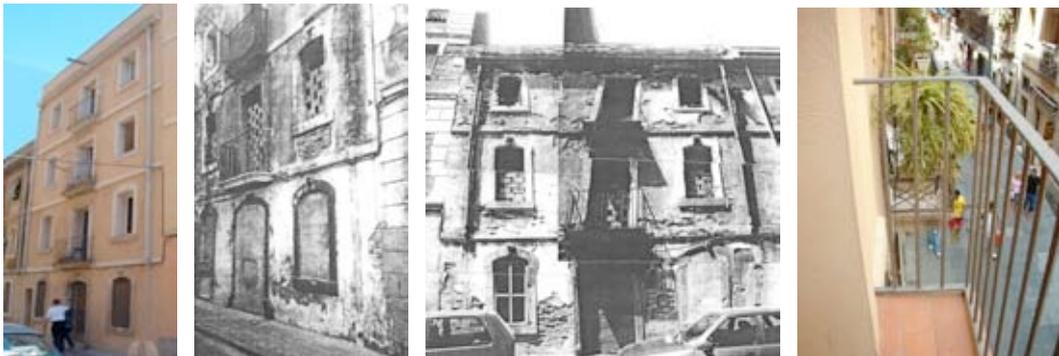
Recuperación de las fachadas, paramentos, balcones, cornisas y elementos decorativos.
